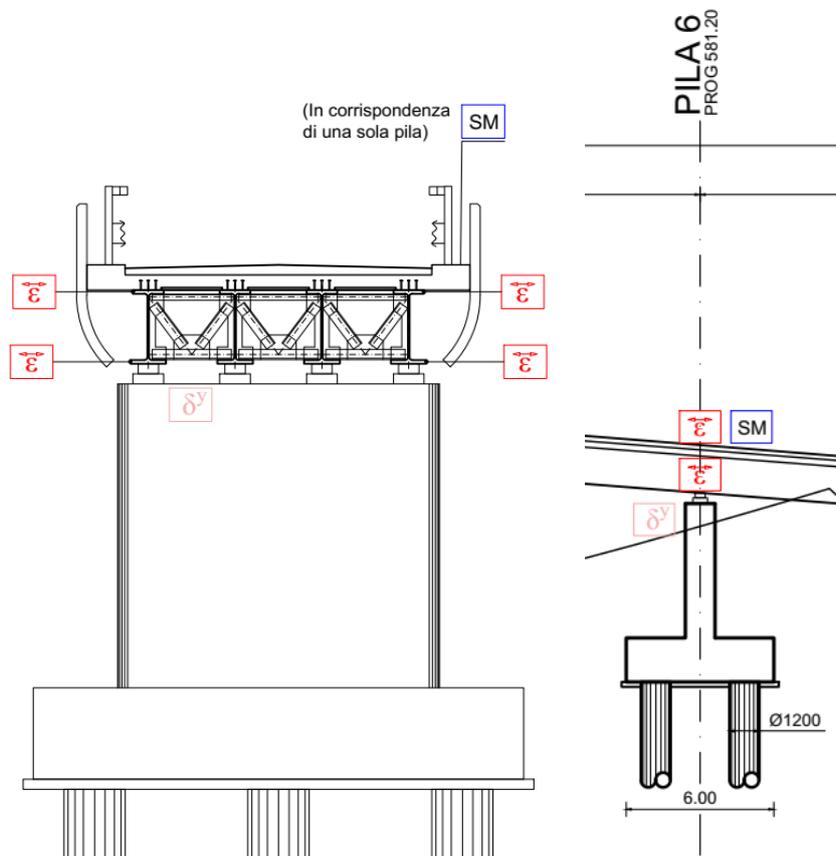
Ubicazione sensori su pile (sezioni e fondazione viadotto MdP)
